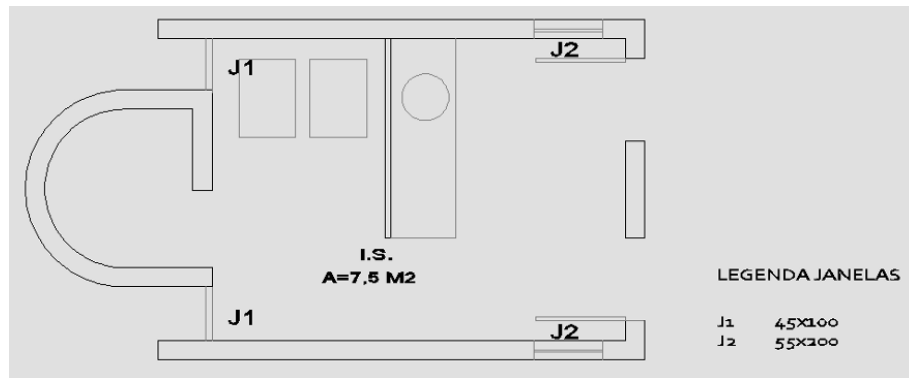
Planta banheiro pavimento superior – indicação de áreas de aberturas.
